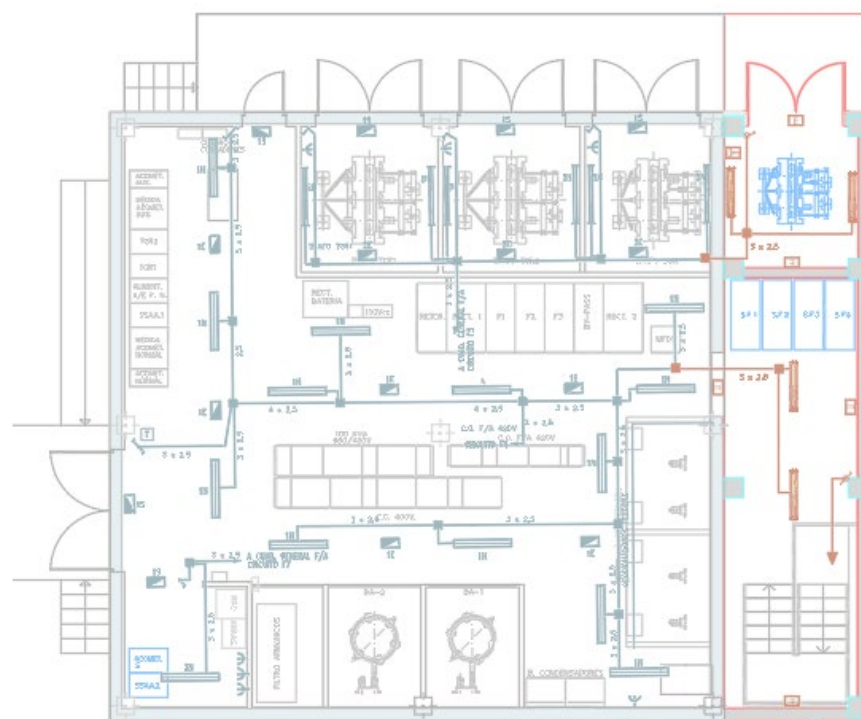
Planta de alumbrado (planta superior), existente y de nueva instalación
